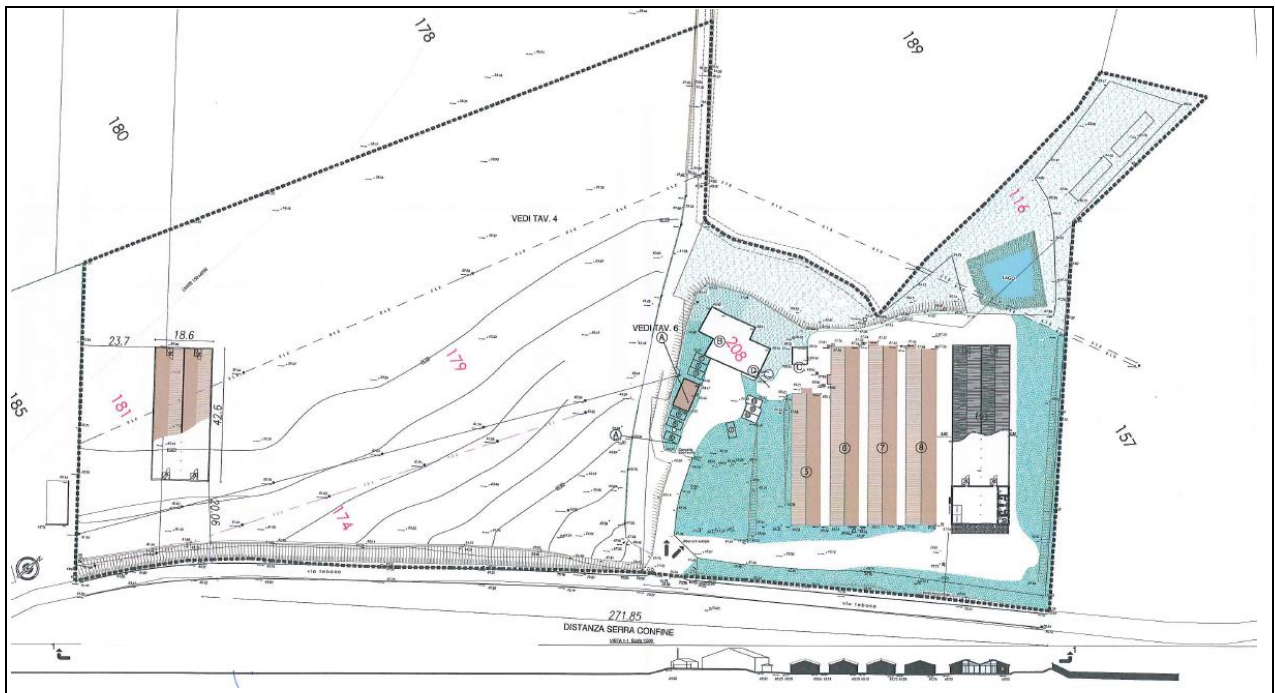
Planimetria area d'intervento con le strutture esistenti e l'organizzazione dell'intera area.
